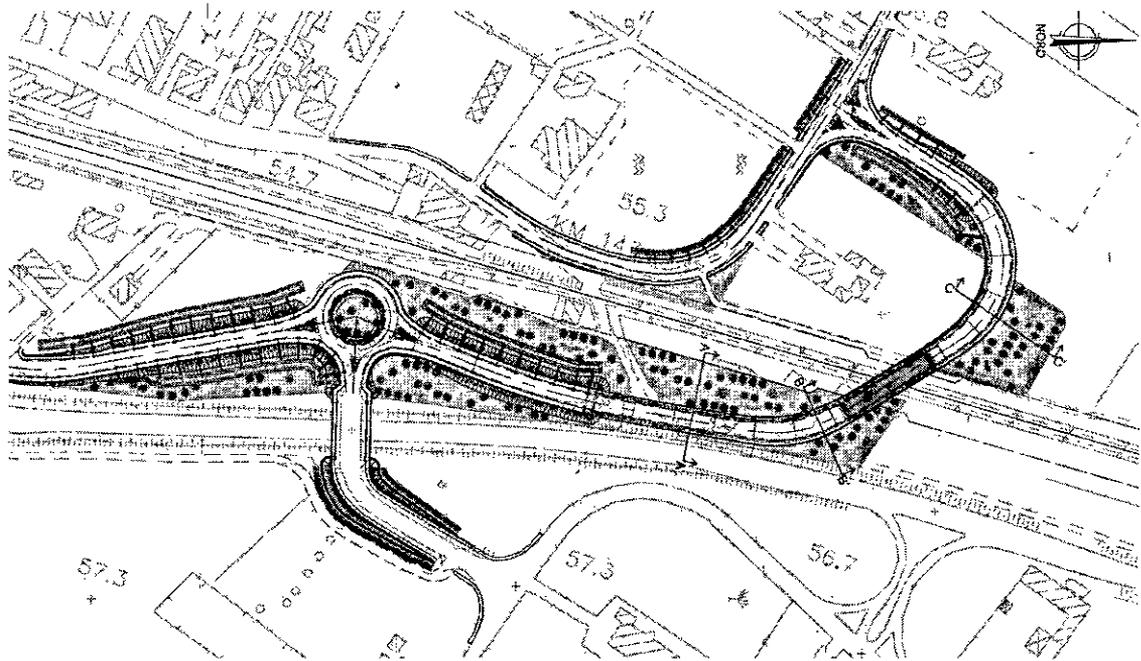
Stralcio della Tavola "Progetto delle opere a verde – planimetria, sezioni e sesto d'impianto" (estratto dal Progetto Esecutivo)
